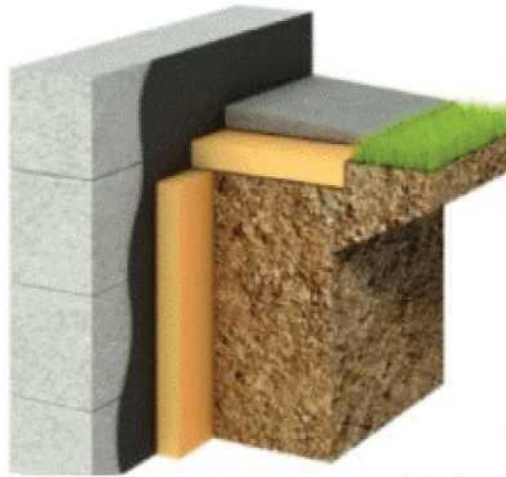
Теплоізоляція та гідроізоляція фундаменту
